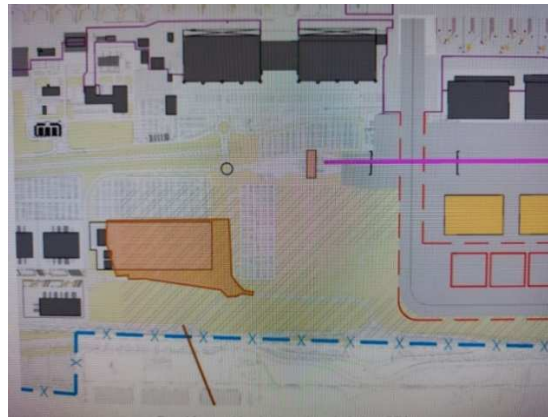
Sovrapposizione Pass4core Alternativa 2 – Accessibilità
